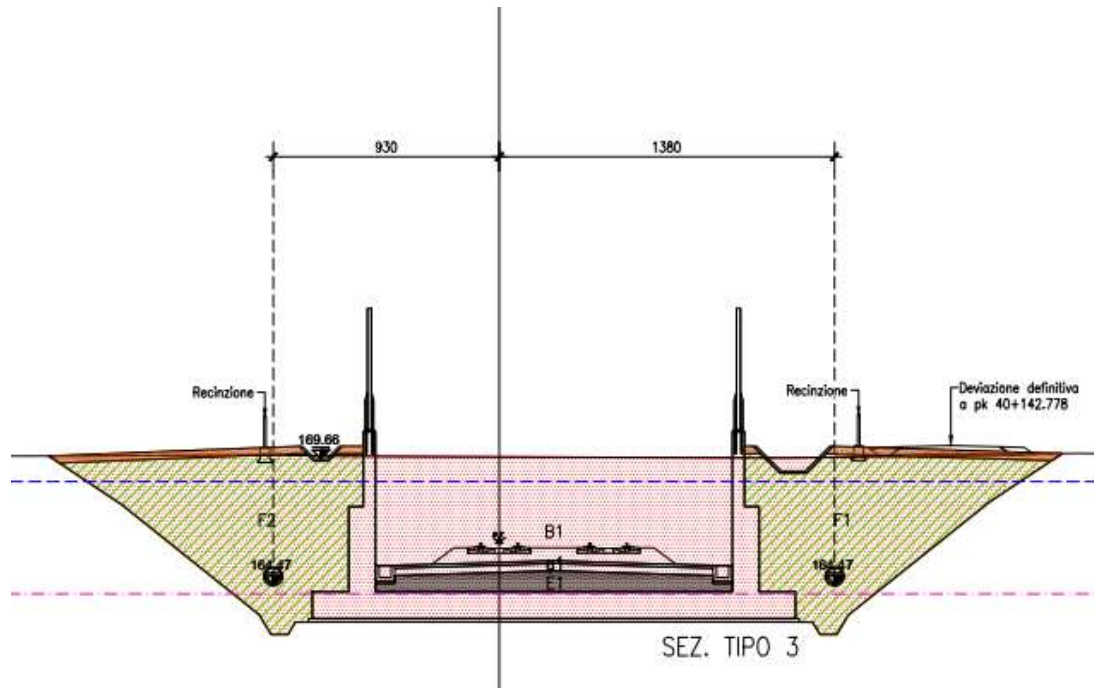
Ambito 10 – Pozzolo SUD Sezione tipo - revisione muri U fino a piano campagna
